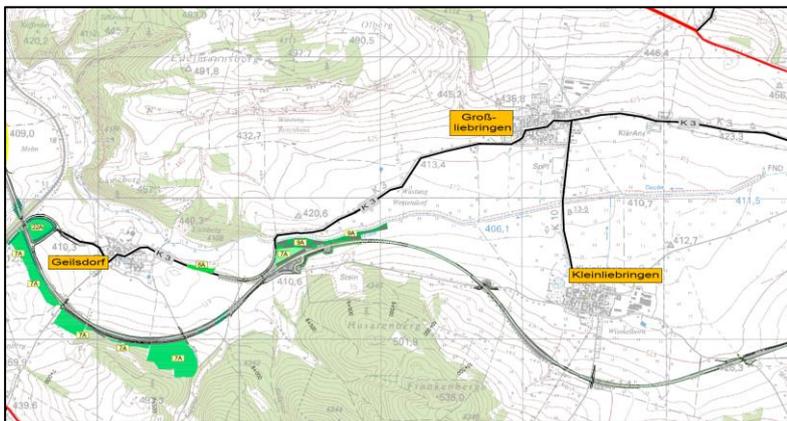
Planausschnitt Landschaftspflegerische Ausführungsplanung Neubau der B 90n zw. BAB 71 (AS Stadtilm) und Nahwinden (L1048) [15]
